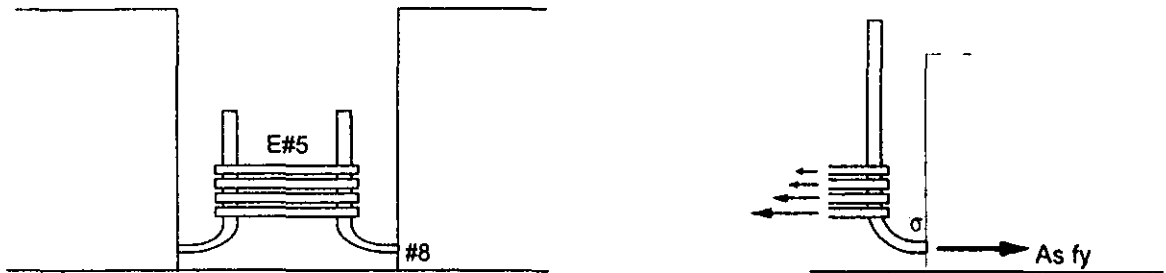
Estribos de continuidad del acero de refuerzo positivo de las traves
